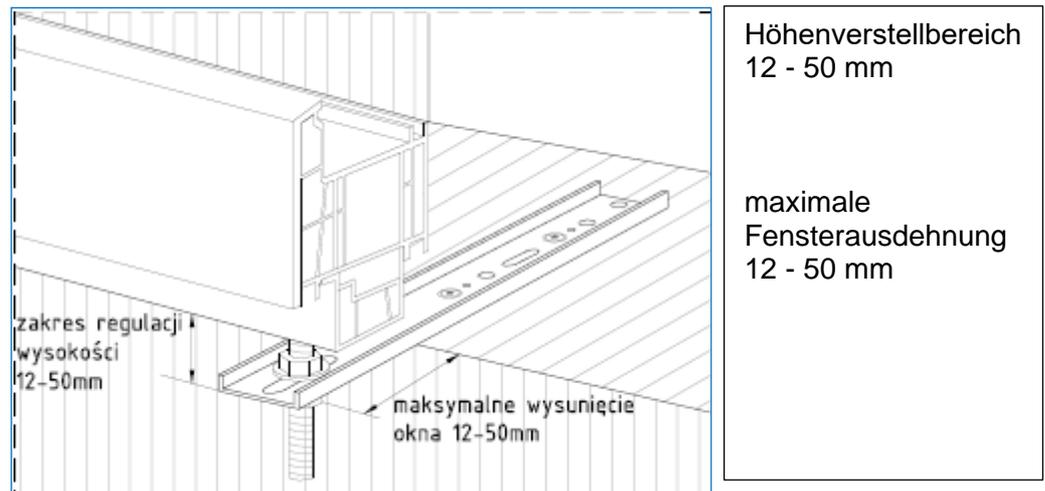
Beispiele für die Befestigung des unteren Fensters mit Metallwinkeln
